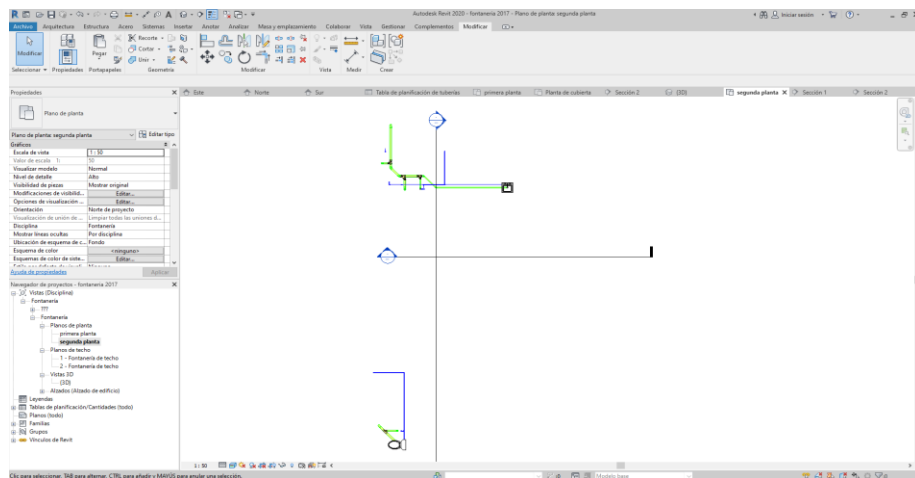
Segunda Planta Plano Hidráulico y sanitario. Revit. Fuente elaboración propia.
